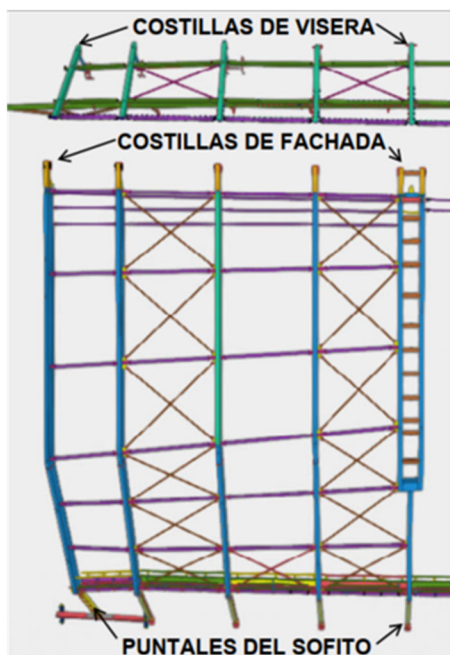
Principales elementos estructurales de la estructura de soporte de la fachada
